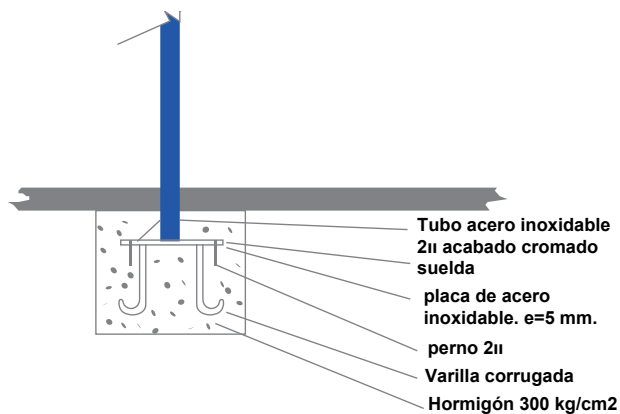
Plano de detalle para cimentación de cicloparqueaderos
